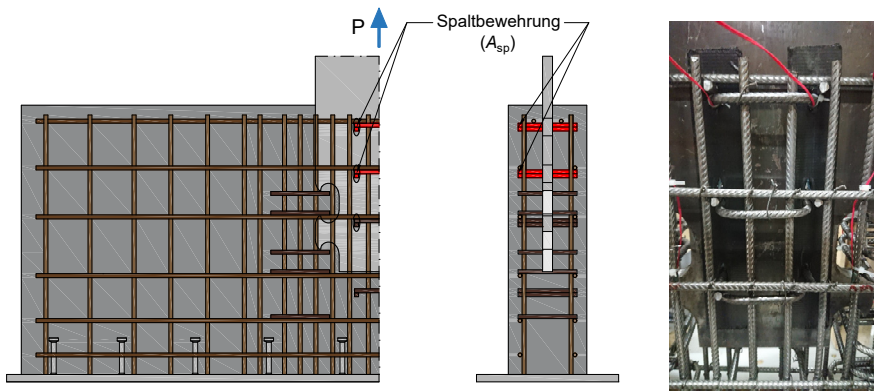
Darstellung des Einbaus der erforderlichen Spaltbewehrung ( $A_{\text{sp}}$ ) mit Bild des Versuchskörpers VR5-ZV-3
